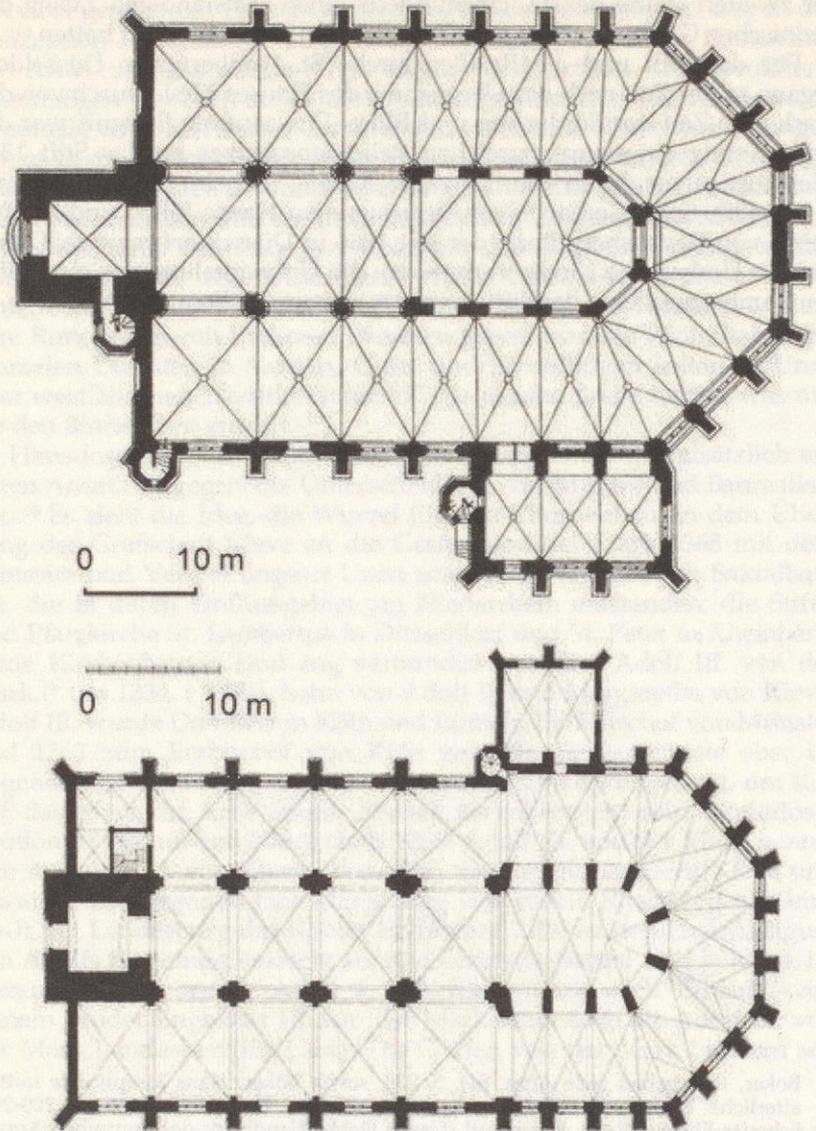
Grundrisse rheinisch-märkischer Kirchen
